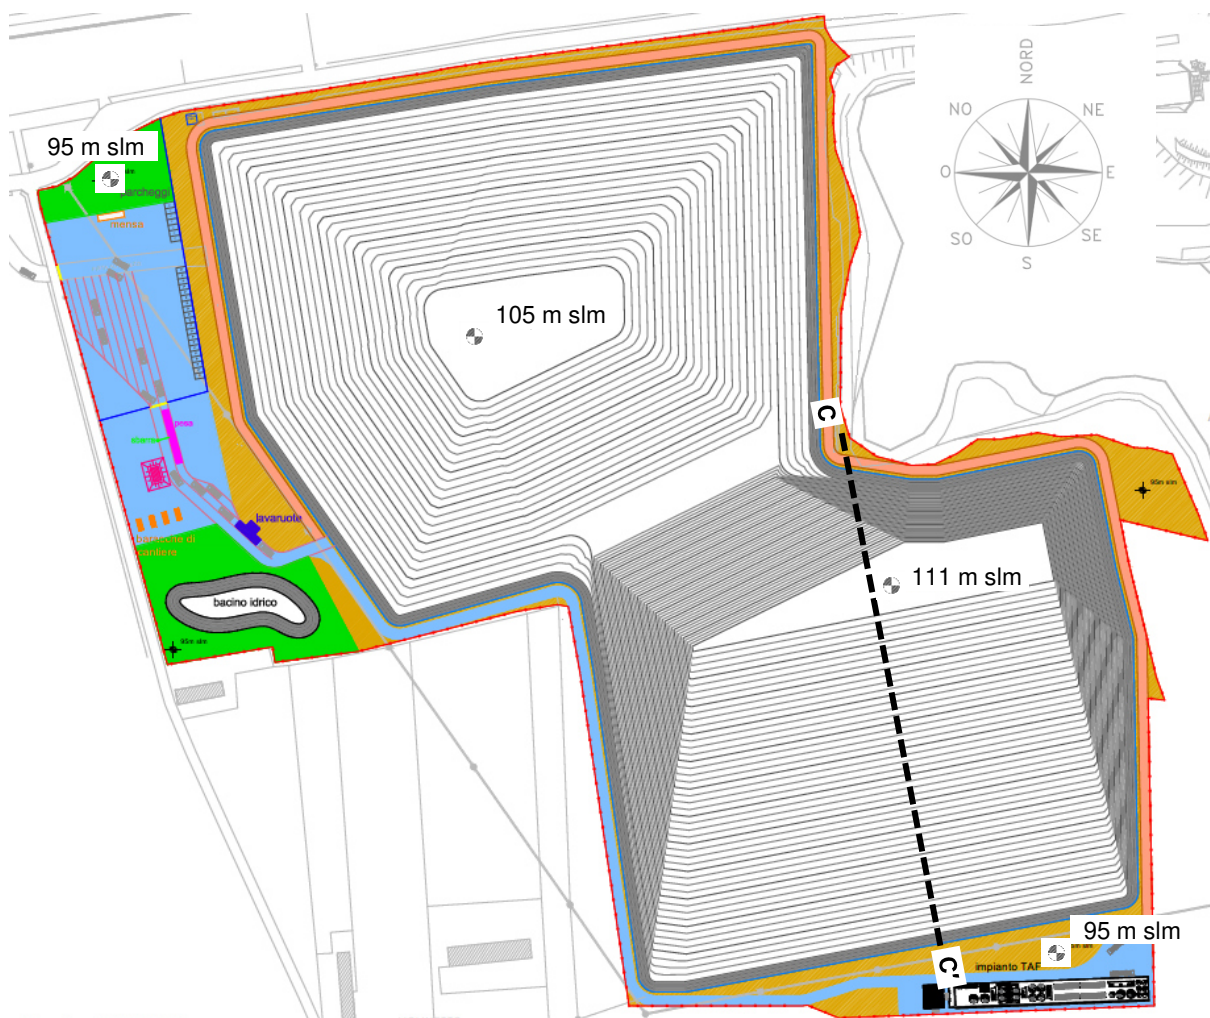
Traccia della sezione C-C' nel settore sud dell'impianto utilizzata nel calcolo dei cedimenti del terreno di fondazione.
